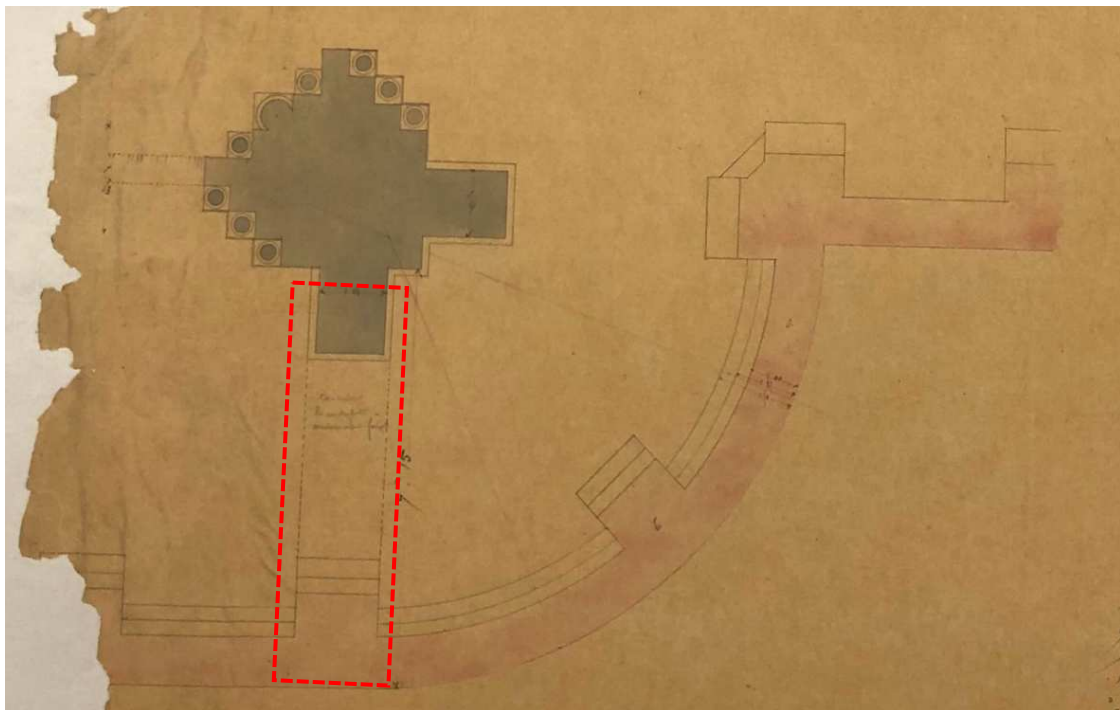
Plan du mur de soutènement / [HI -04] 1860
